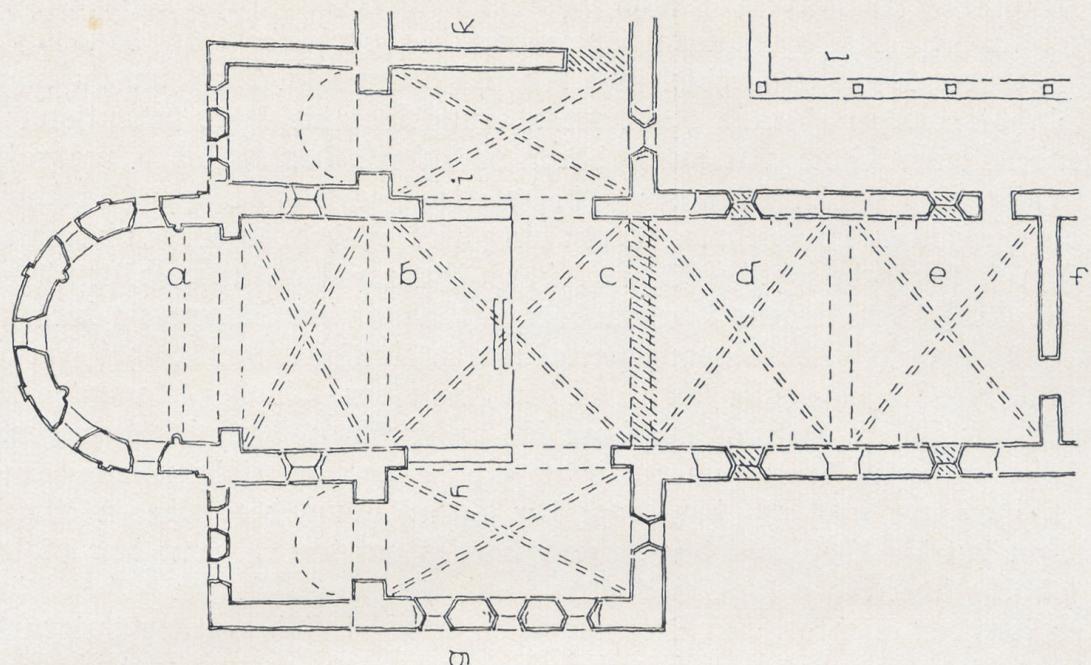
Fünfte Kirchenperiode, Grundriß 1:300.
